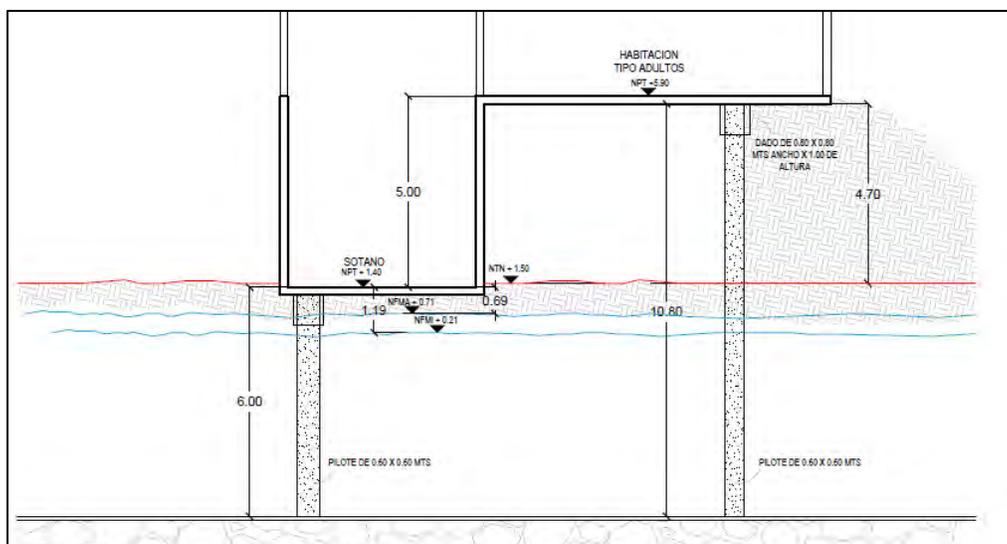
Croquis nivel de empotramiento de los pilotes para desplantar la cimentación.
